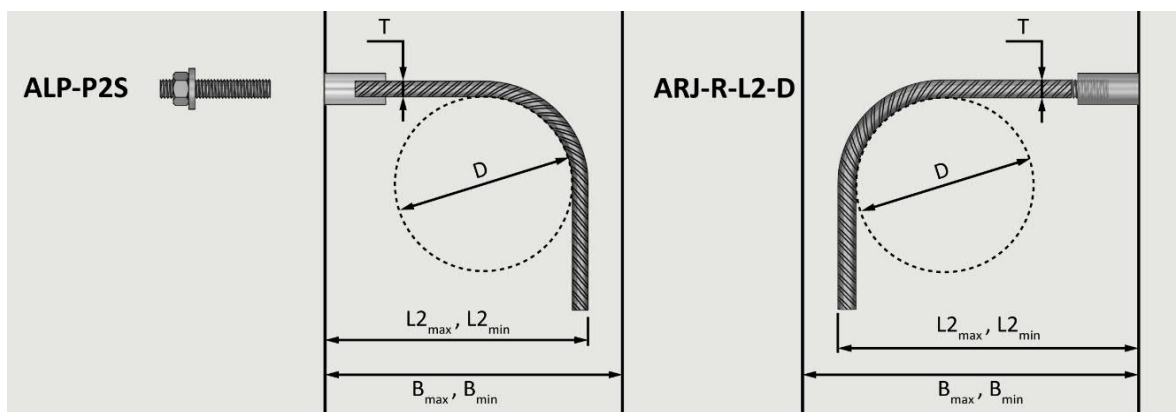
Taivutetun ankkurointipultin sijoitus ja lisäraudoitus pilarissa
